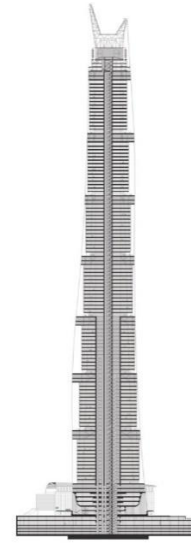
Shangai Tower dış görünüm (ArchDaily, 2021b)
